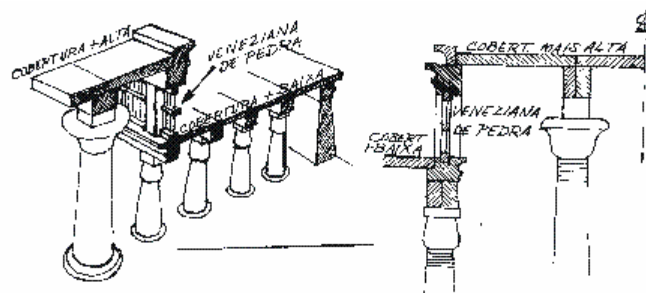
Detalhes de acabamento. Fonte: BOLTSHAUSER (1963)
